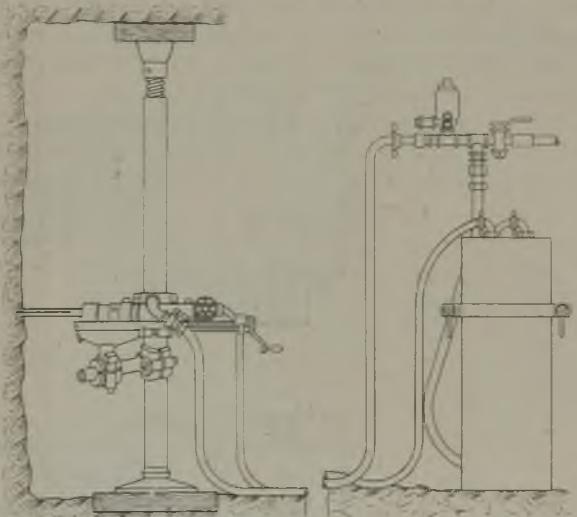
Preßluftbohrmaschine mit Spülwassereinführung. Leyner Engineering Works, Denver, Colorado.
